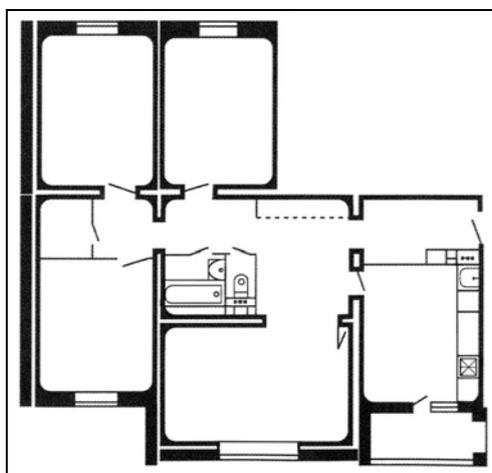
План 4-комнатной квартиры в многоэтажном объемно-блочном здании, г. Минск
